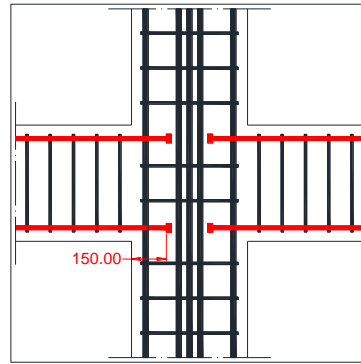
15 Detail Penulangan Hubungan Balok-Kolom Interior Konvensional
